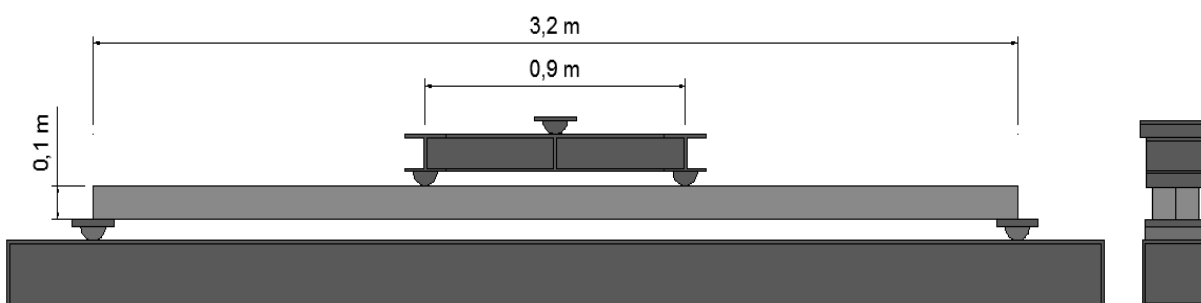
Esquema, longitudinal e transversal, de ensaio com duas cargas pontuais, para os provetes de madeira.
